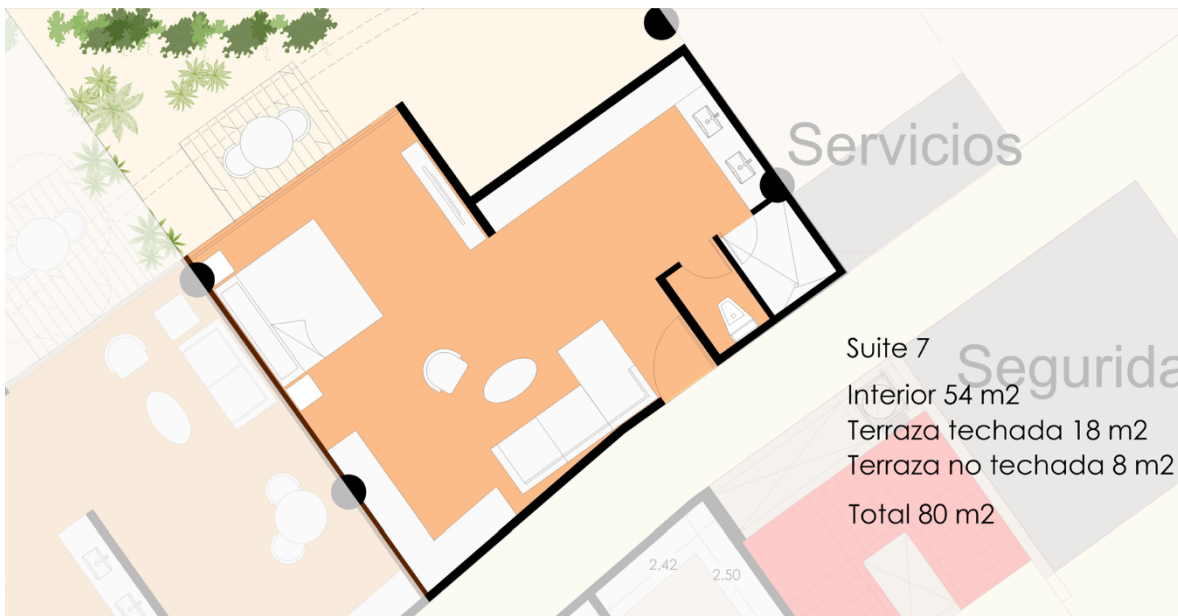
DEPARTAMENTOS SUITE 7 DE PLANTA BAJA
